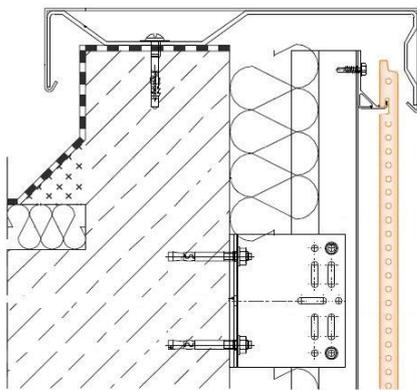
Coronación. FAVEKER® FV. Sistema perfil horizontal.
